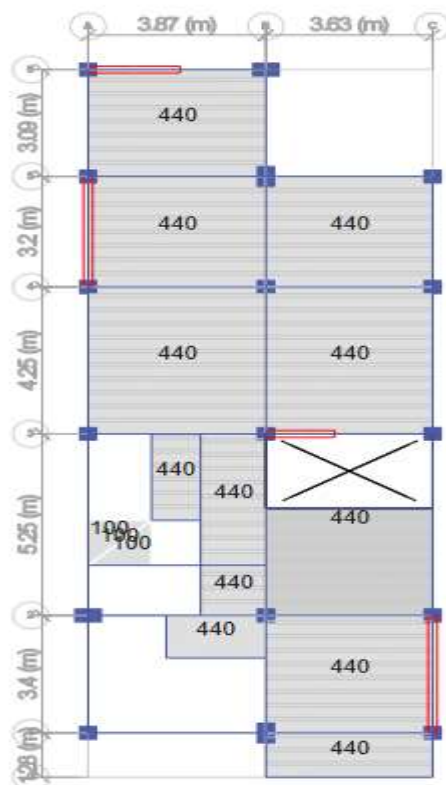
Vista en Planta Carga S dead (carga muerta asignada del 1er al 3er piso)
